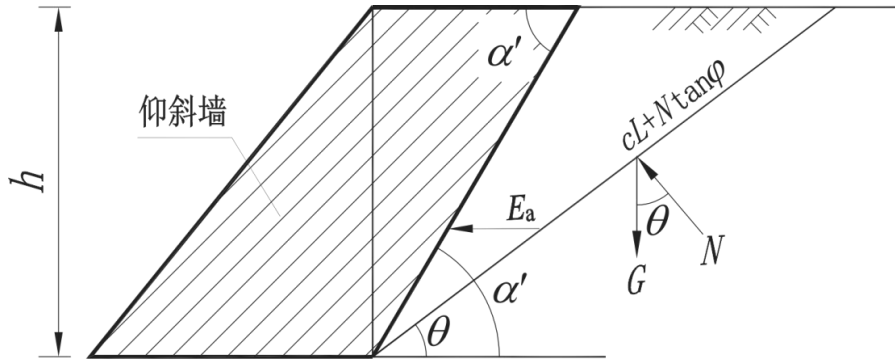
边坡的坡面为倾斜时土压力计算简图
